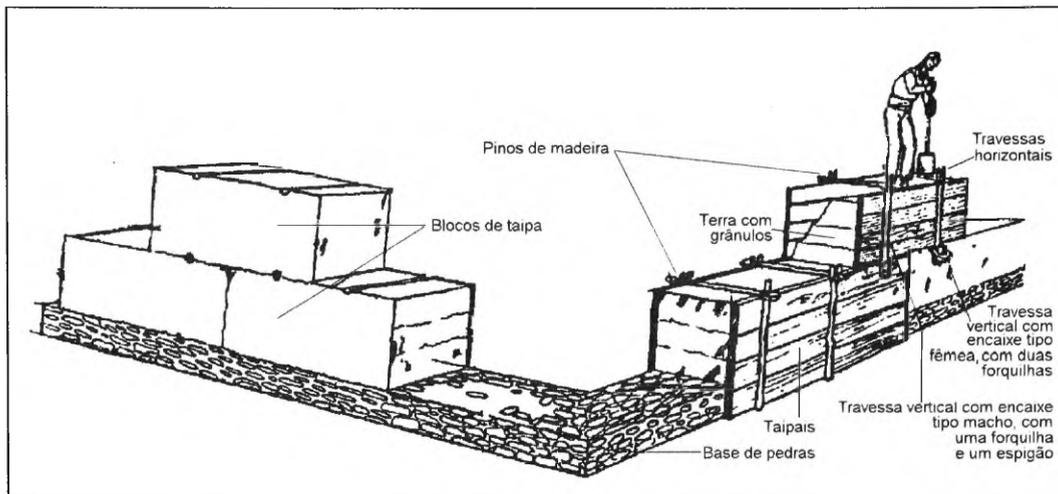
Construção de um muro em taipa de pilão (Blumme, 1985).
